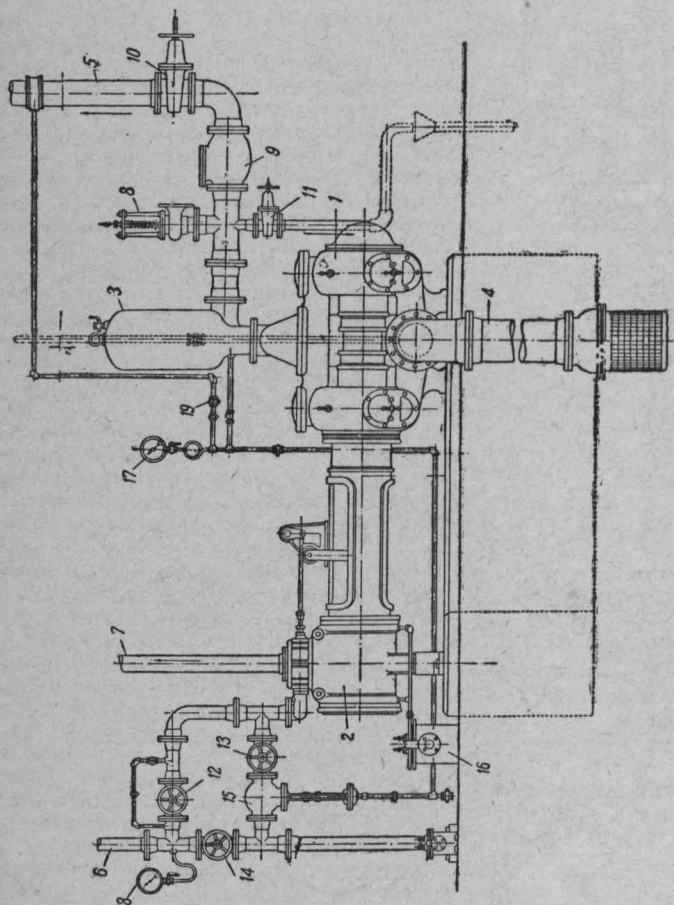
Схема установки парового насоса sprinkлерного оборудования: 1 — насосные цилиндры; 2 — паровые цилиндры; 3 — воздушный колпак; 4 — всасывающий трубопровод; 5 — нагнетательный трубопровод; 6 — паропровод; 7 — паровыпускной трубопровод; 8 — предохранительный клапан; 9 — обратный клапан; 10 — задвижка; 11 — пробный вентиль; 12, 13, 14 — паровые вентили; 15 — автоматический регулятор; 16 — конденсационный горшок; 17 — манометр на трубопроводе к нагнетательной линии; 18 — манометр на паропроводе; 19 — кран на трубопроводе к нагнетательной линии.
